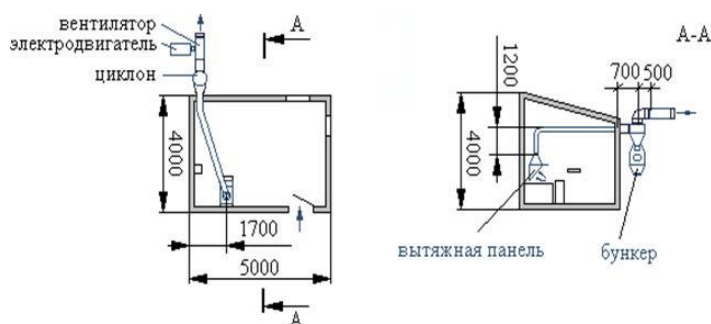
Схема проектируемой вытяжной местной вентиляции
